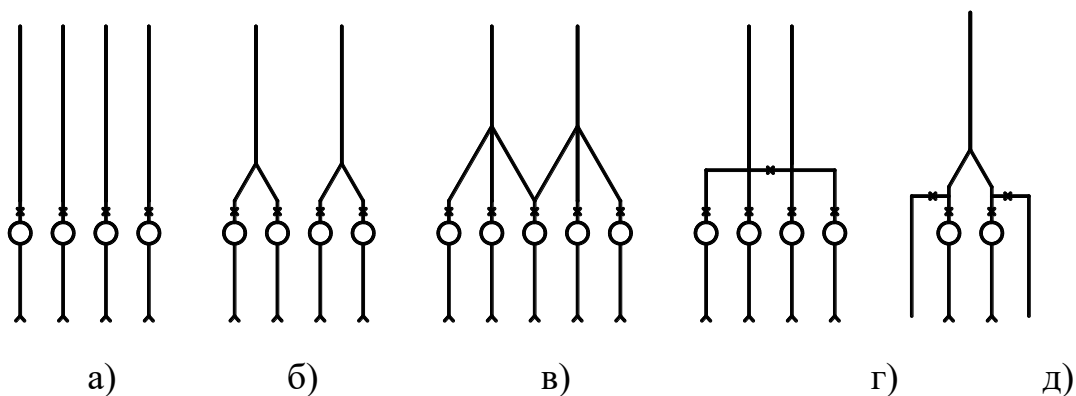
Схемы соединения насосных агрегатов с напорными трубопроводами
